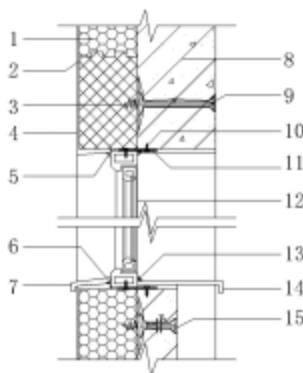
被动式超低能耗建筑窗口部位保温防火组合构造示意
